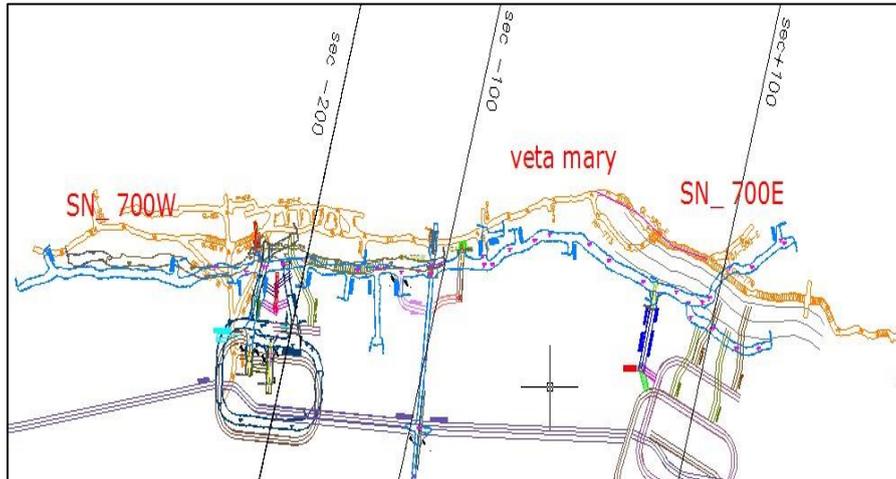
Vista general en planta de la veta Mary con las secciones motivo de estudio
